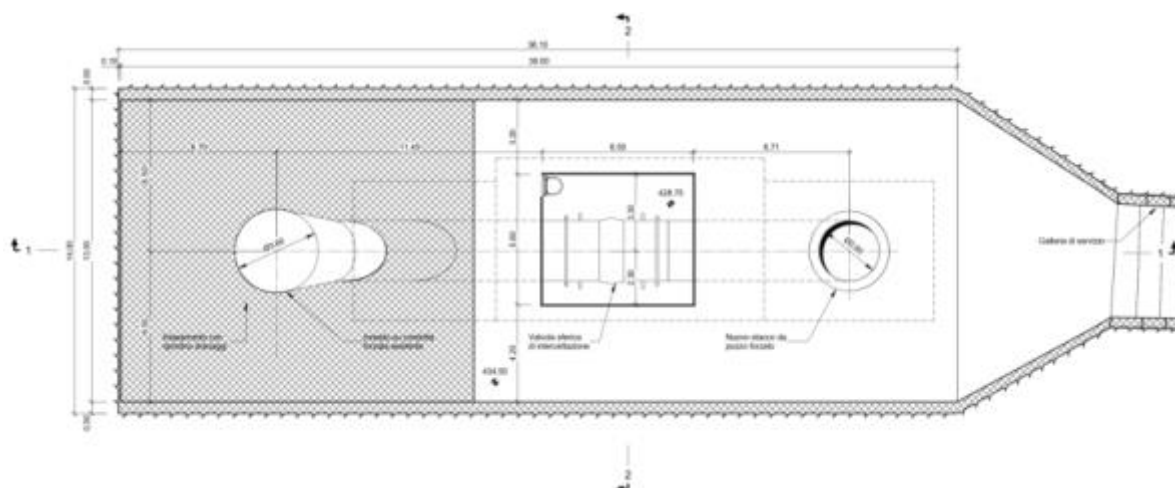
Caverna per la realizzazione del nuovo innesto sul pozzo verticale – pianta
